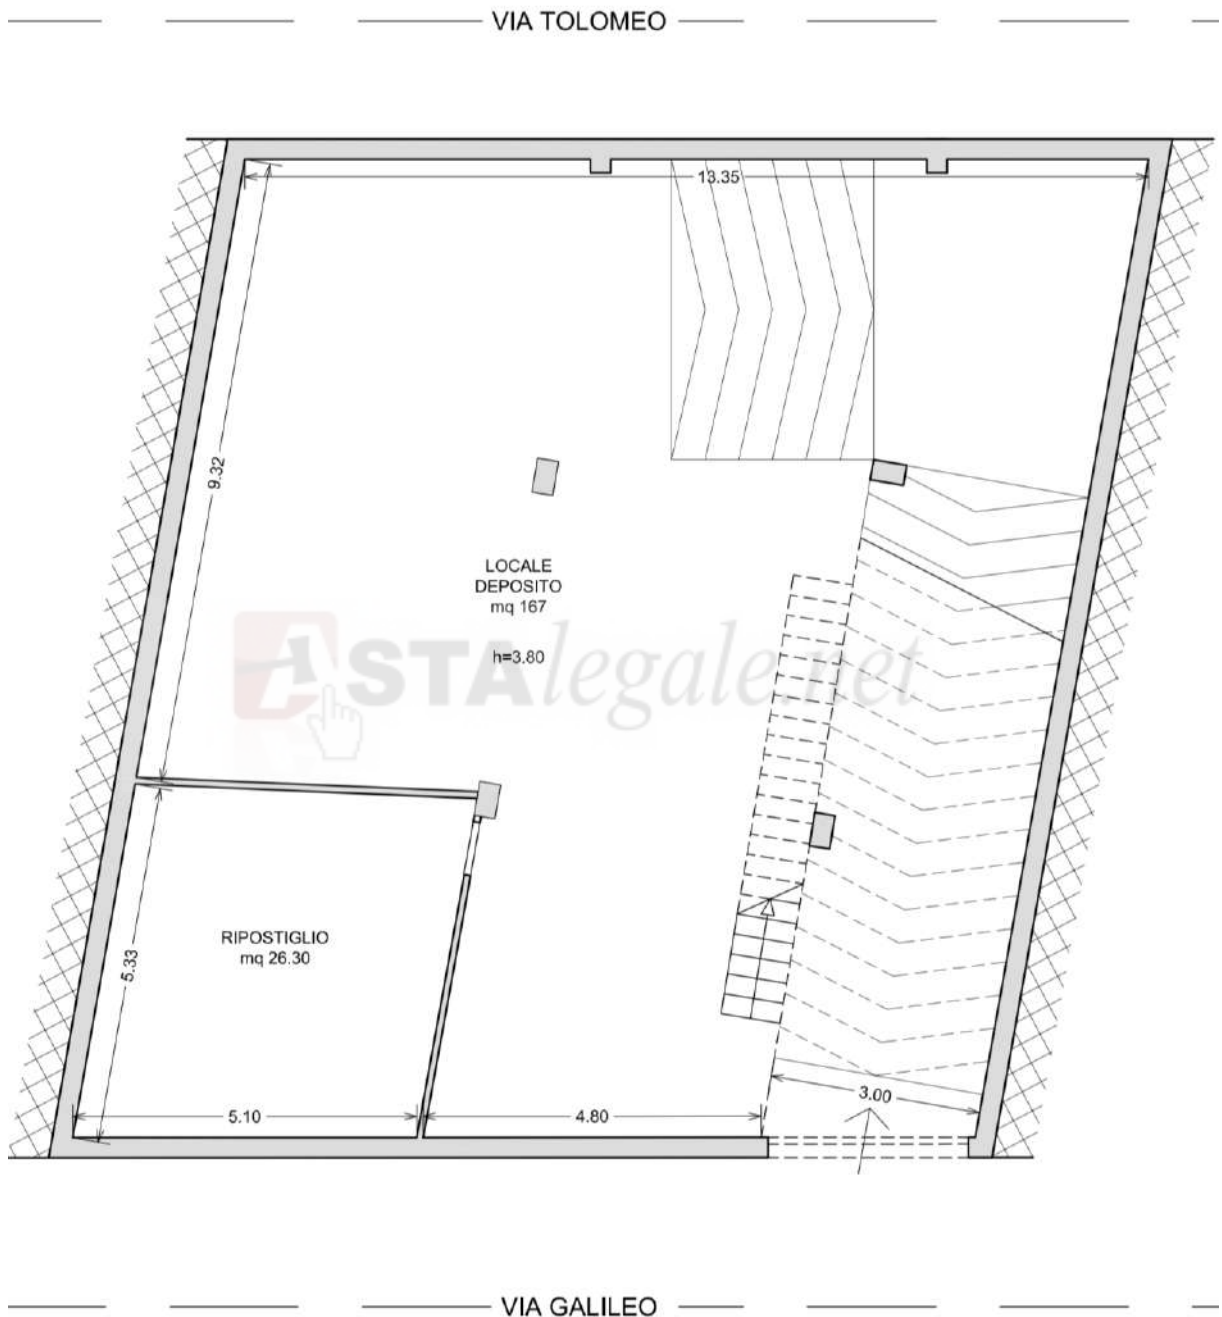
PIANTA PIANO SEMINTERRATO - Sub 2.
